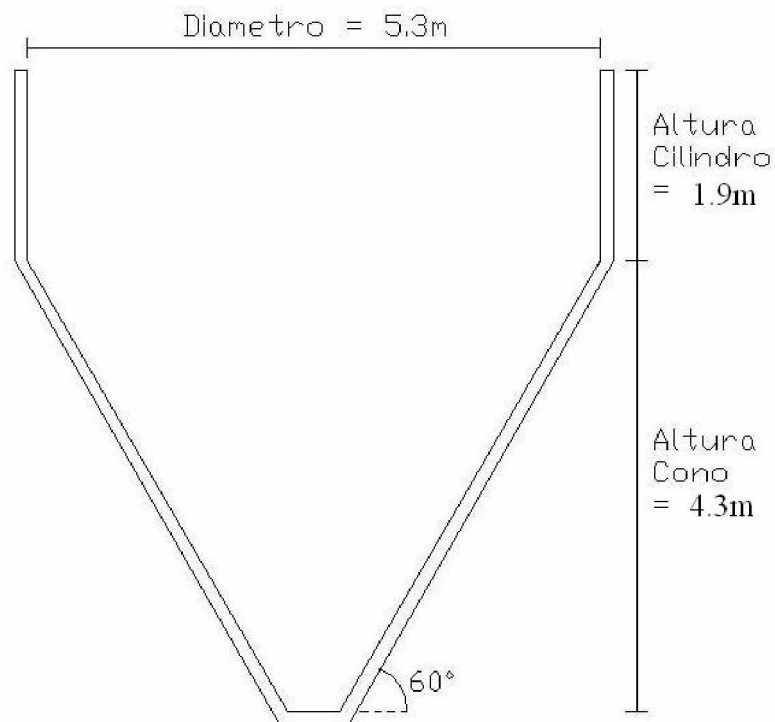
Sección del sedimentador primario de la Planta N°3
